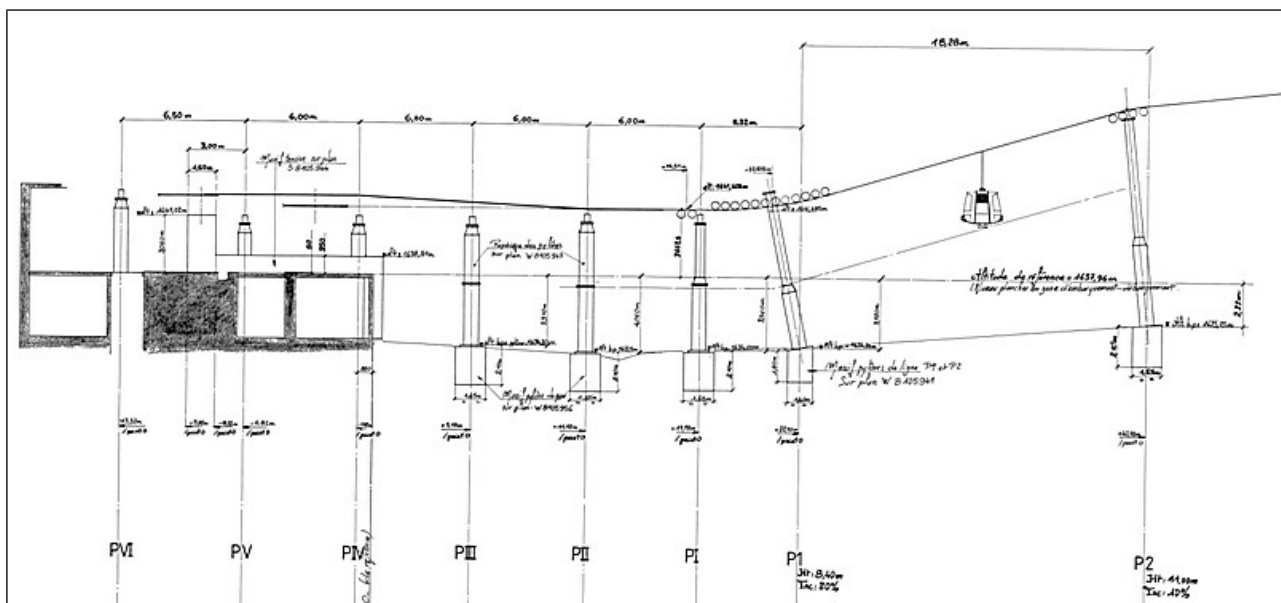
plan d'implantation de la gare basse et des deux premiers pylônes, dont P1
